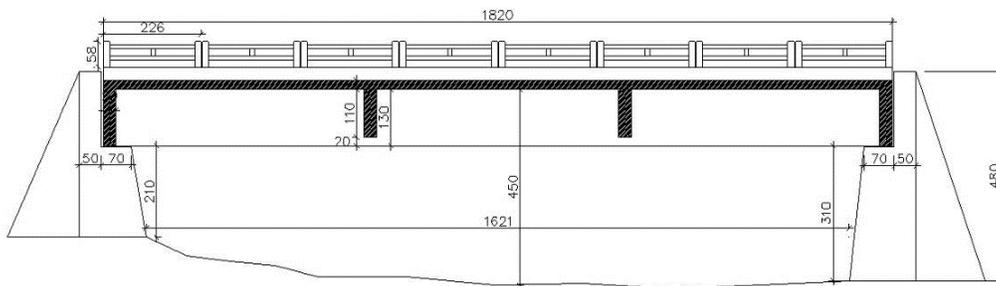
Corte longitudinal da geometria original da ponte de referência.
